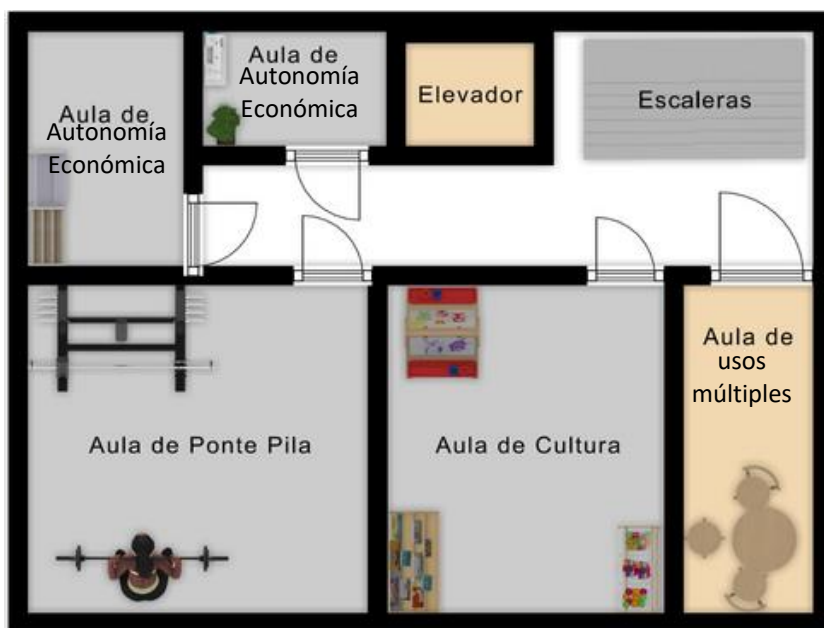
Croquis de PILARES San Andrés Ahuayucan- primer piso
